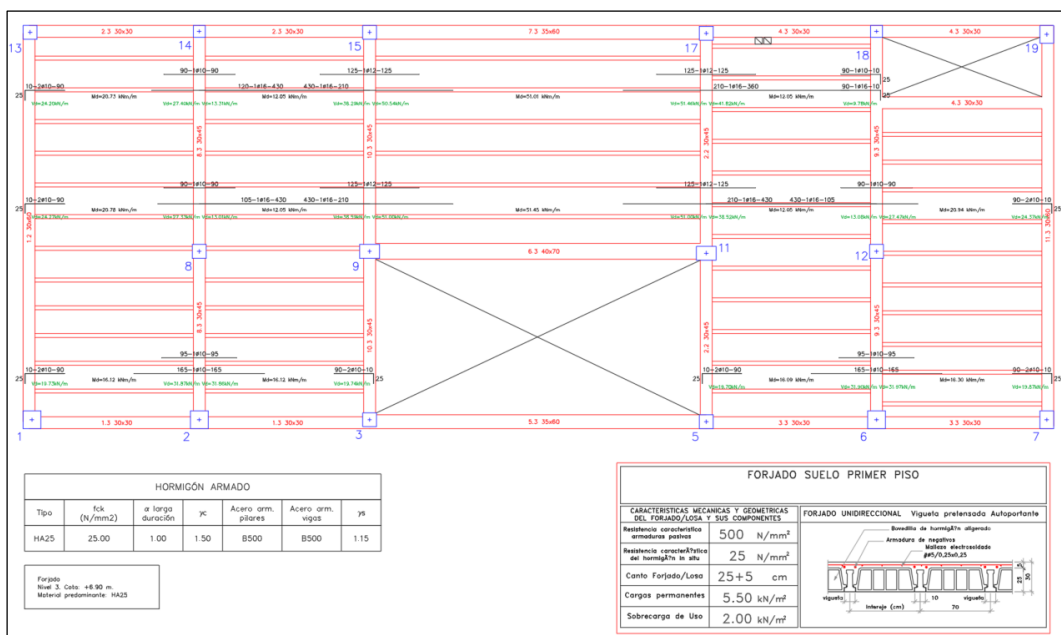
Plano de forjado con la posición de las viguetas y los shunts
